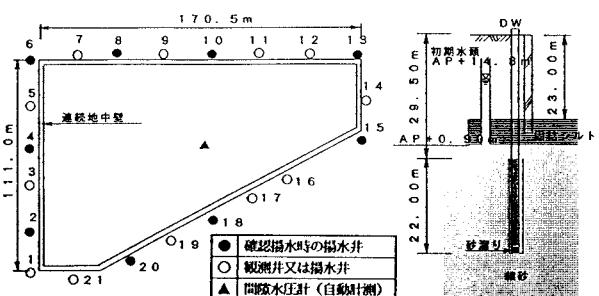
掘削平面図、断面図及びDW、間隙水圧計配置図
